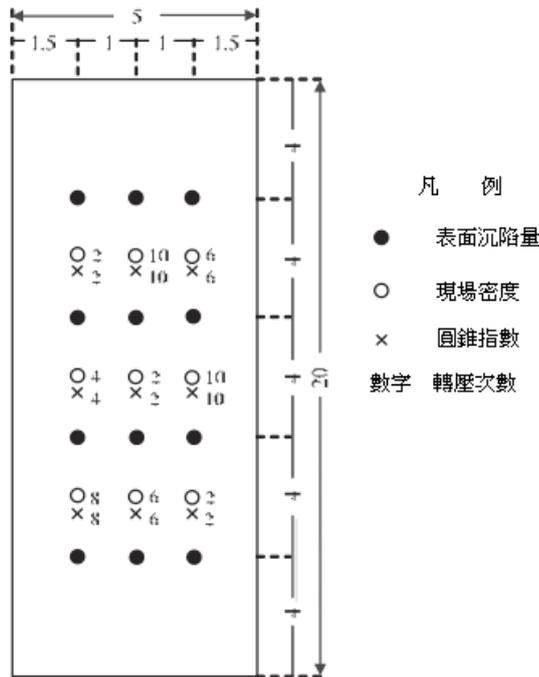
試驗性施工之試驗項目與測點配置圖舉例
